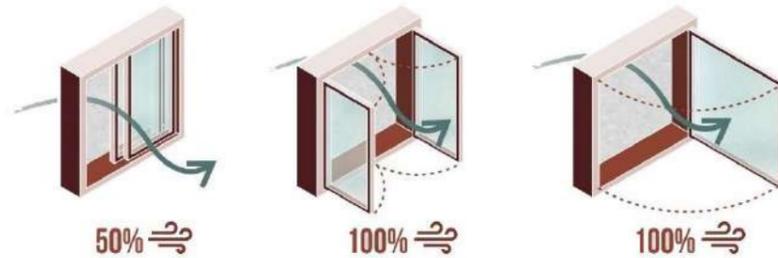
Tipos de aperturas. Adaptado de Plataforma Arquitectura.
